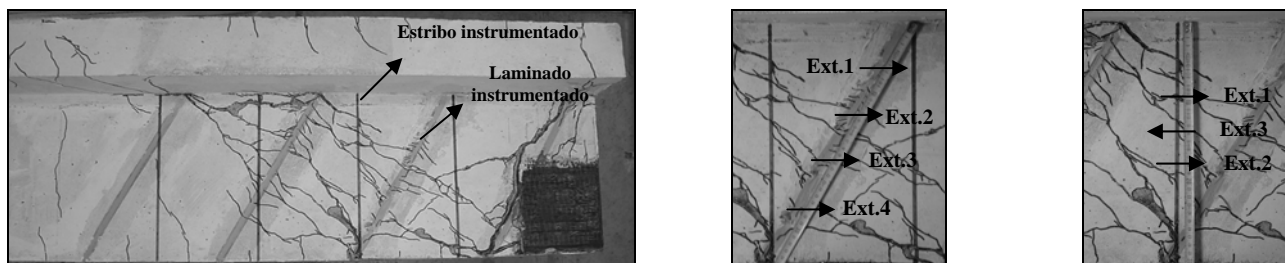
Localização dos extensómetros no laminado e estribo instrumentados da viga 4S-4LI60-B.
